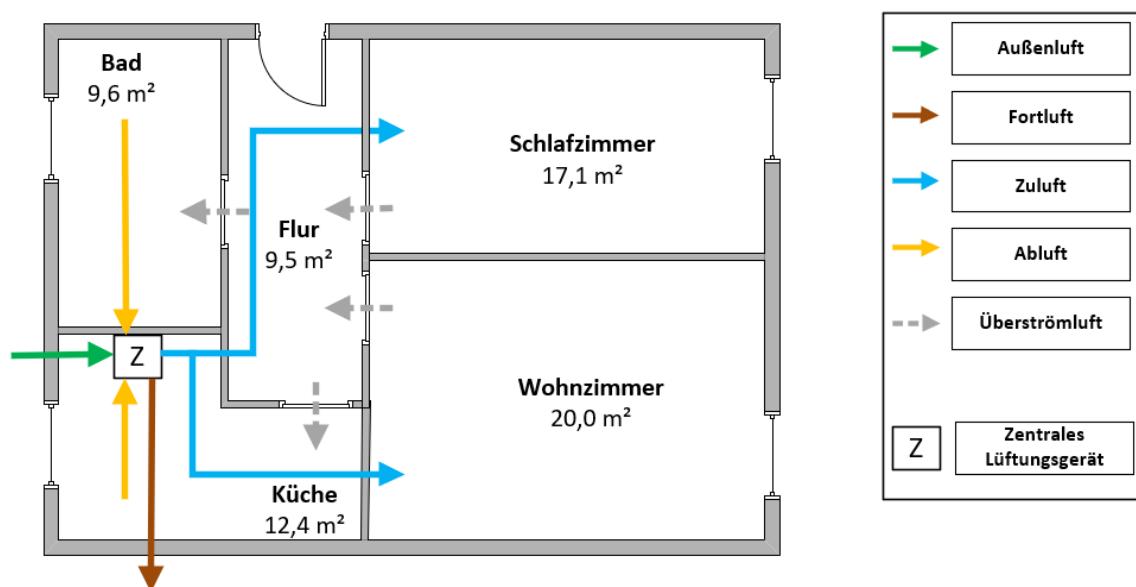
Grundriss Zwei-Zimmer-Wohnung, Schematische Darstellung zentrales Lüftungssystem
